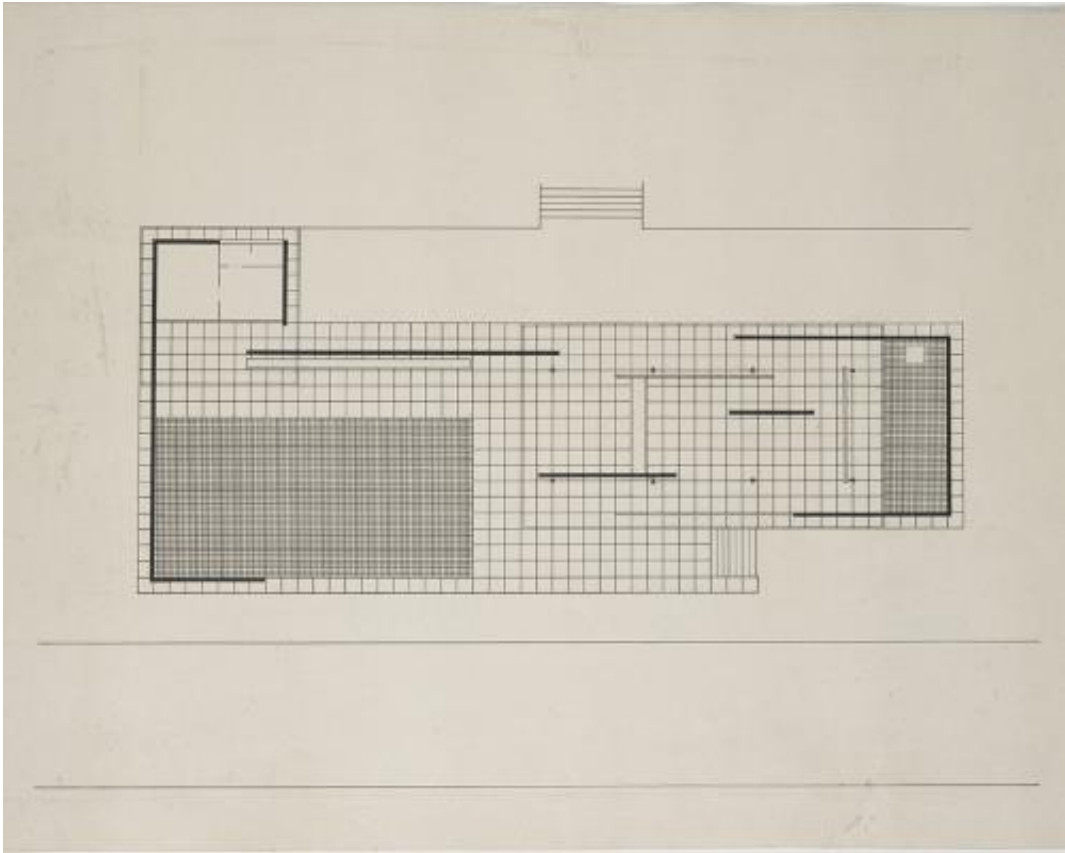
ภาพผัง The Barcelona Pavilion grid plan (1929)
